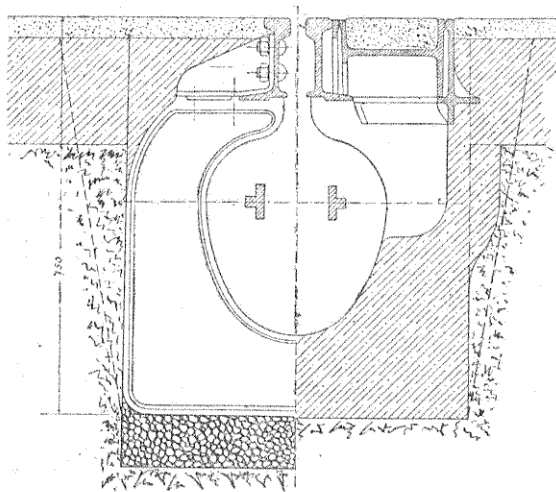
Coupe du caniveau Siemens de Berlin.
